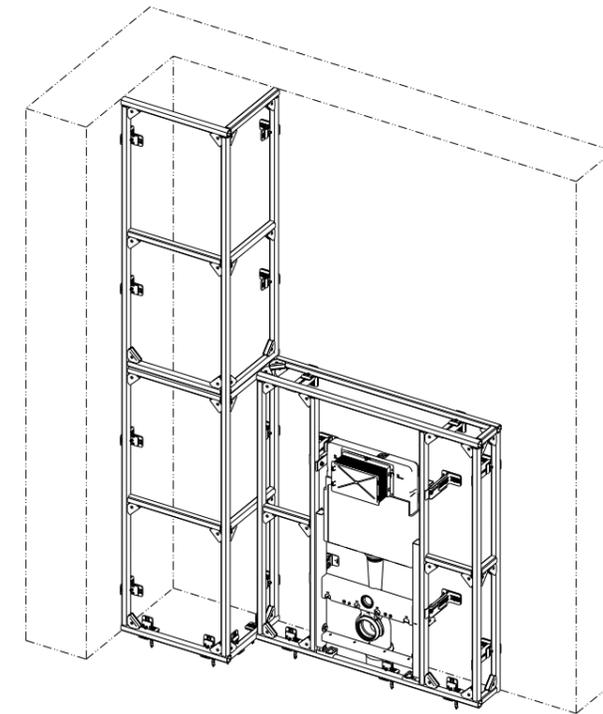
Konstruktion vor der tragenden Wand mit Schacht – unterschiedliche Tiefe der Konstruktion des Schachtes und der Vorwand
